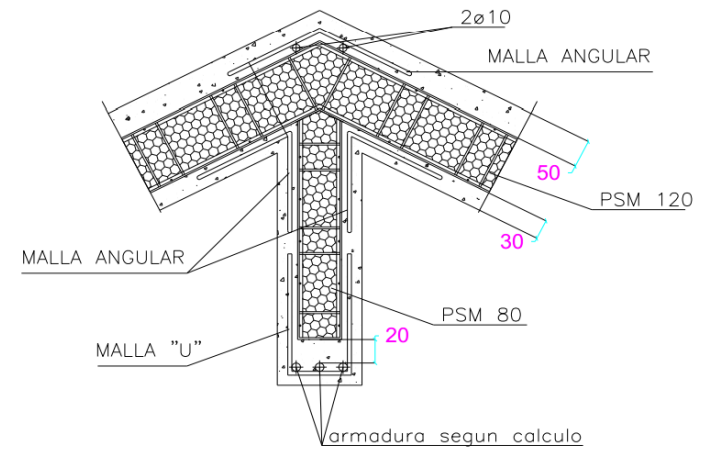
Viga de Cubierta. Fuente: Casa Pronta, www.casapronta.com
